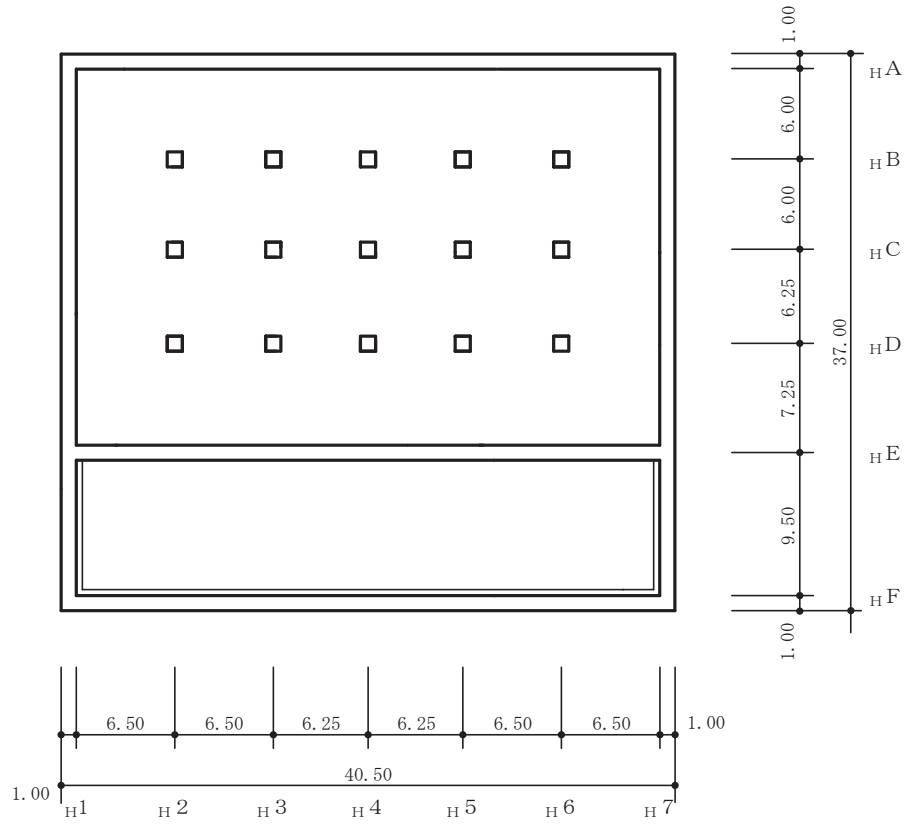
(1) 第 3 号機海水熱交換器建屋の概略平面図 (O.P. -9.5m)
